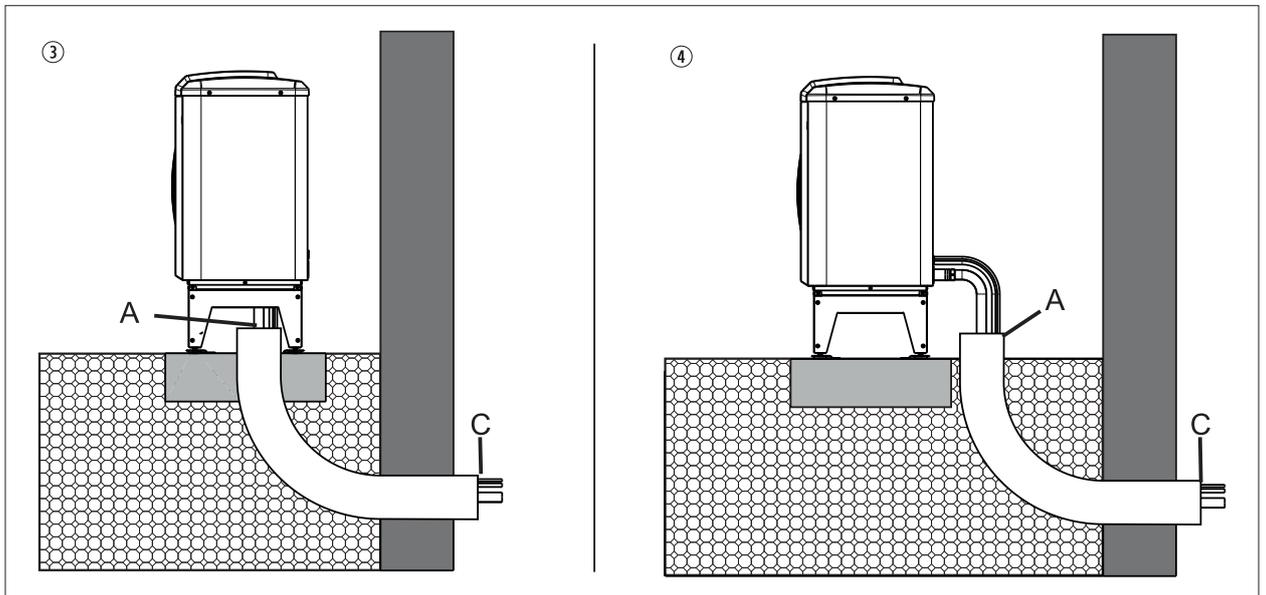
Canalizzazione a muro al di sotto del terreno
